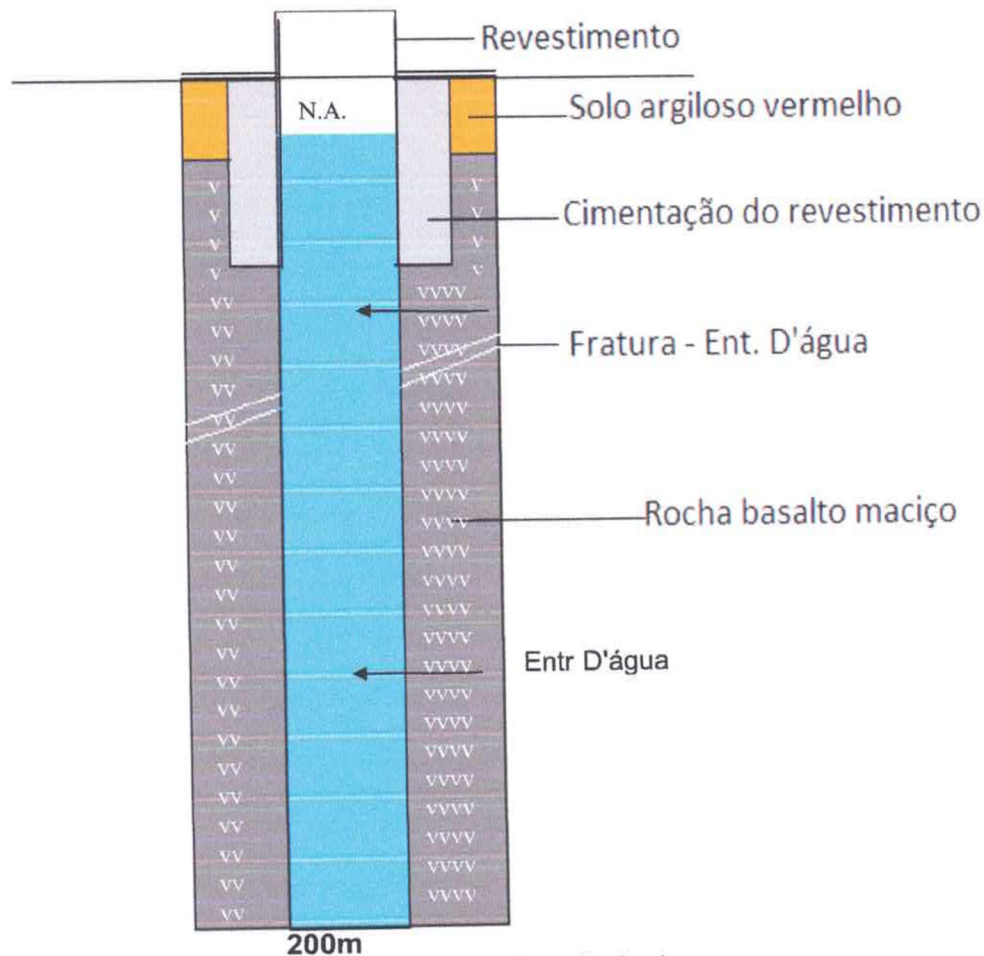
Perfil Geológico e Construtivo do Poço Profundo
